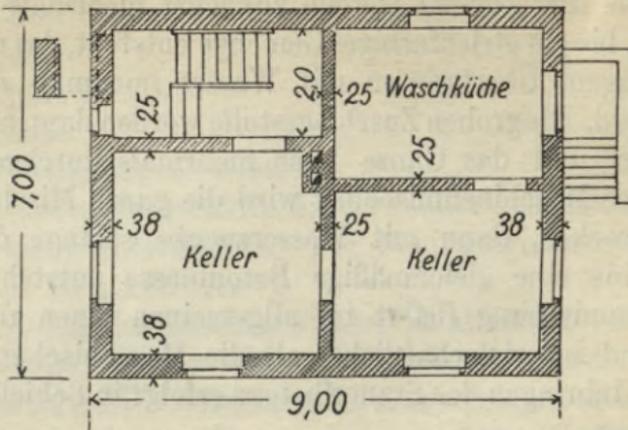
b. Arbeiterwohnhaus: Kellergeschoß-Grundriß.
